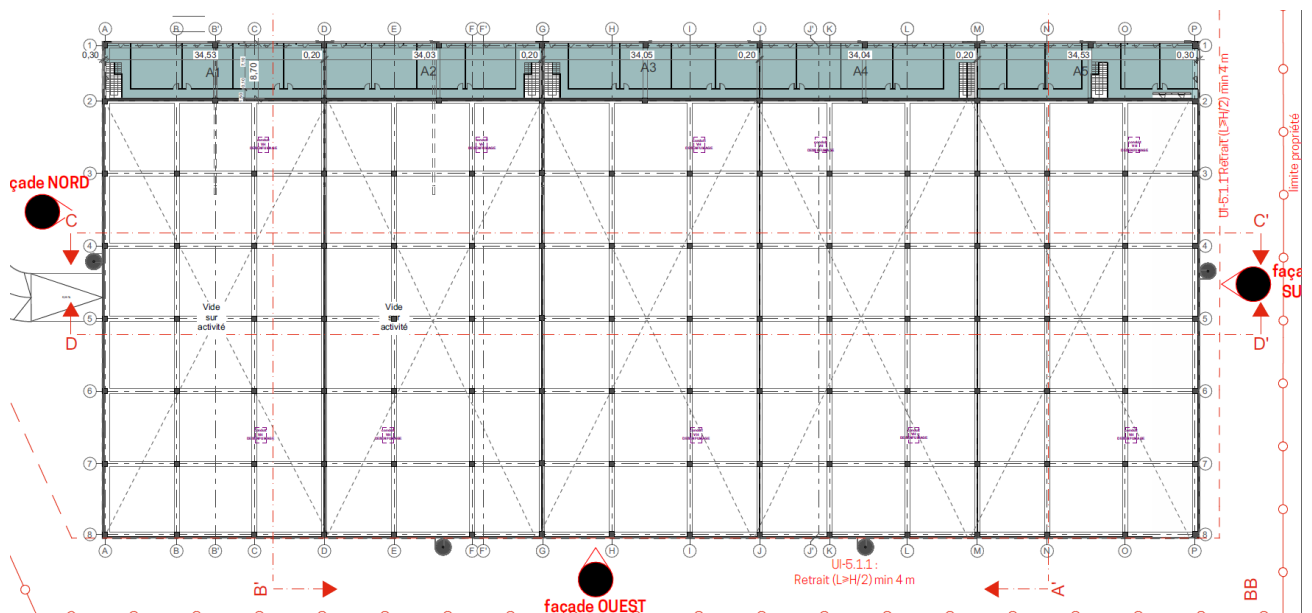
Vue en plan du R+1 (Mezzanine du RDC)[4]
